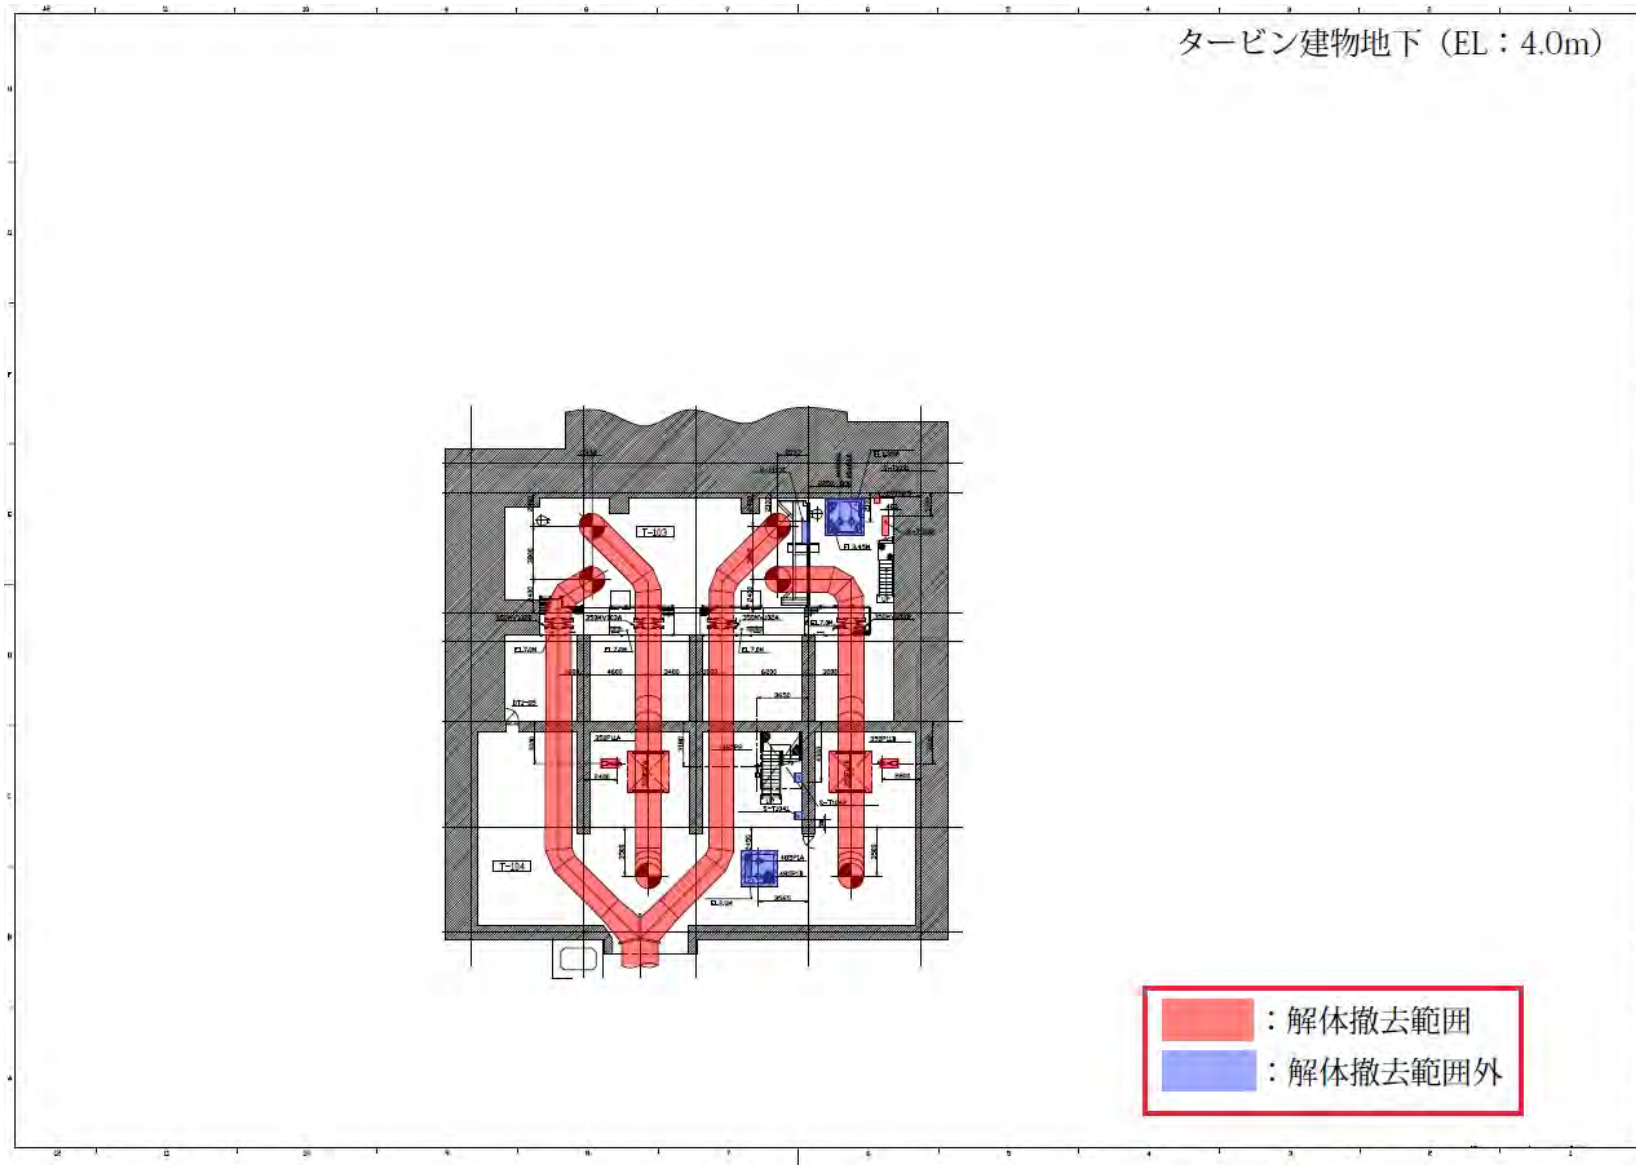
主な解体撤去機器 (タービン建物平面図) (7/7)
